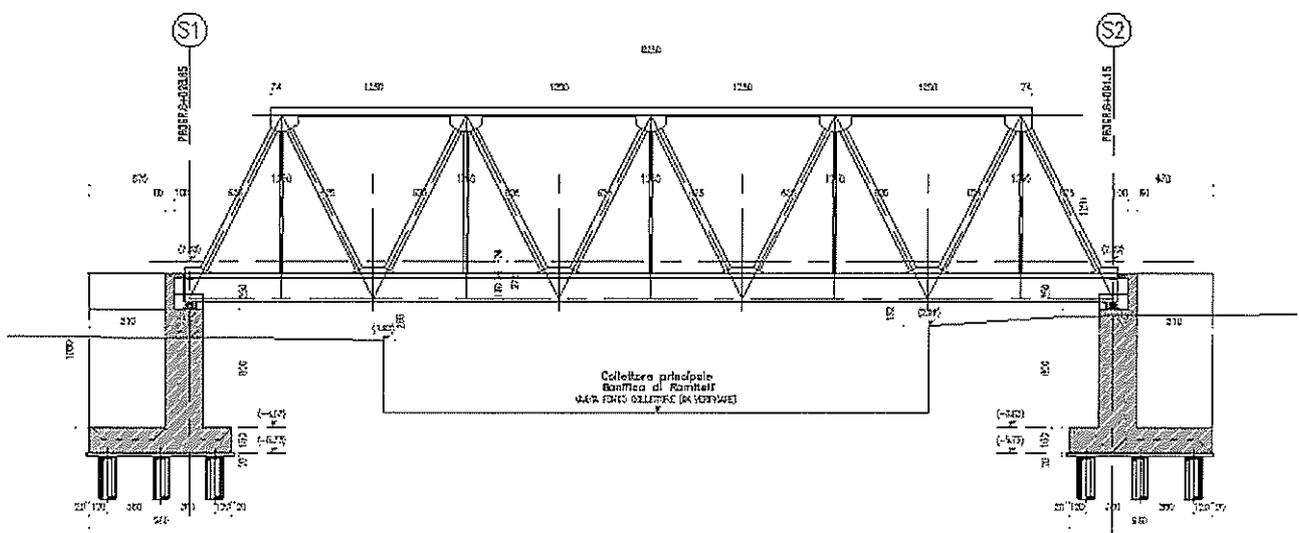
Travata metallica sul collettore "Bonifica di Ramitelli": sezione longitudinale
